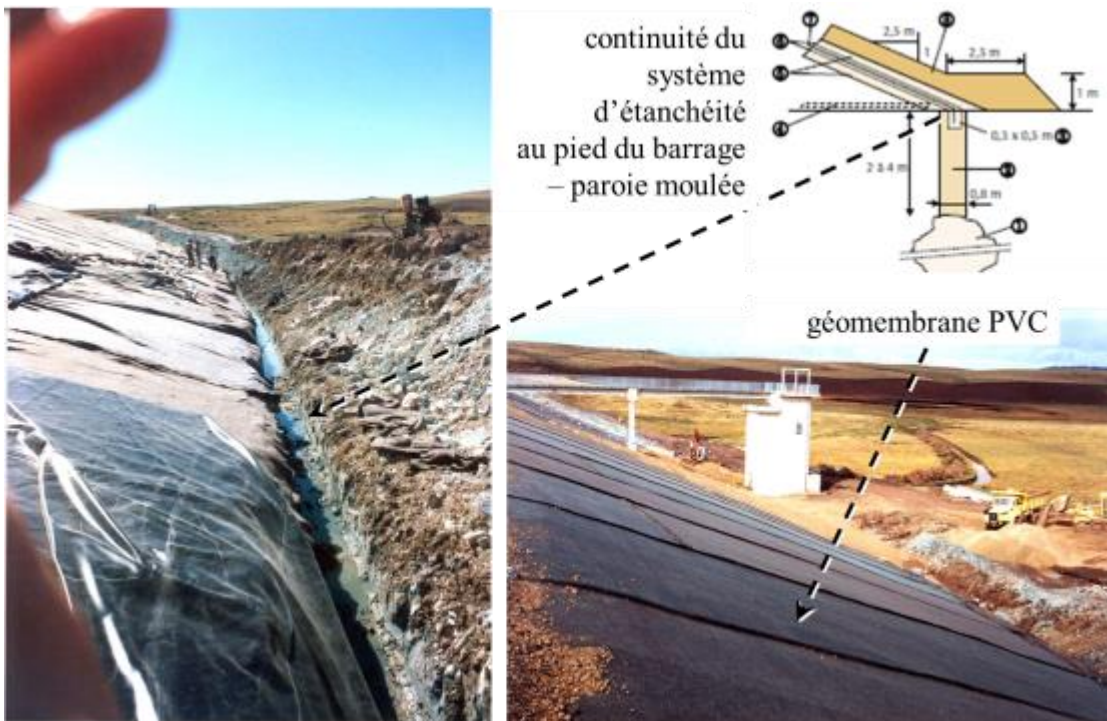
Barrage de l'Aubrac : connexion entre la géomembrane PVC et le rideau vertical en paroi moulée afin d'assurer une continuité de l'étanchéité (1986).
